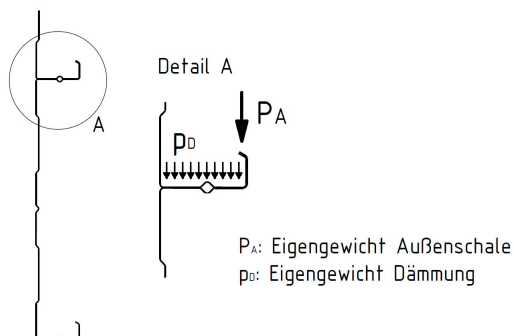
Kassettenprofile in Fassaden unter Vertikallast
